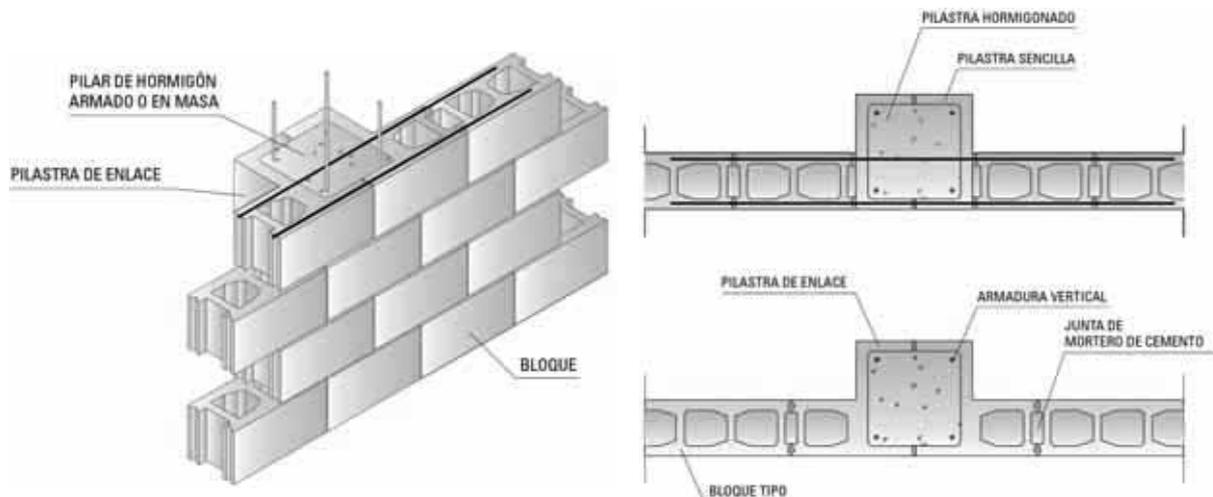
Pilastra con piezas especiales. Introducción de armaduras y formación de pilar.
